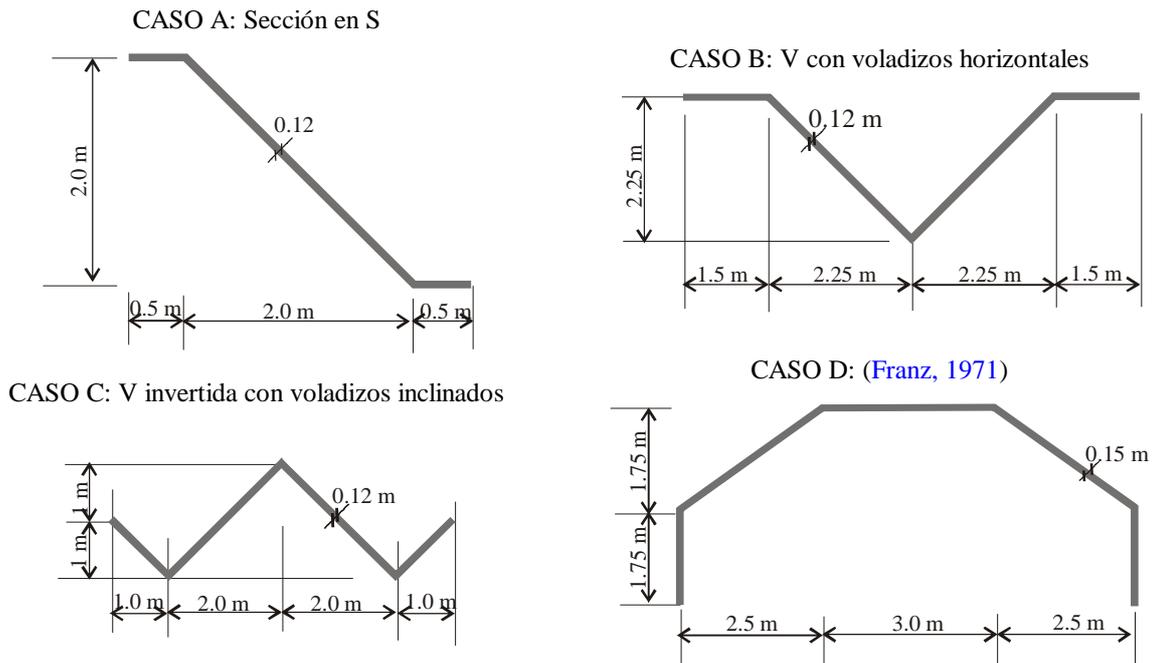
Secciones transversales para el ejercicio N° 2 del TP N°3
